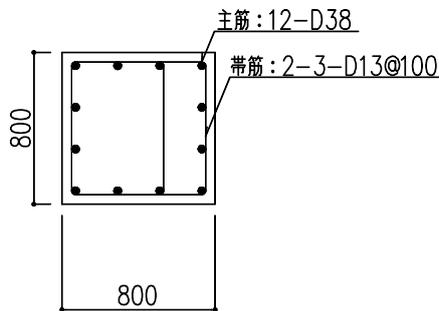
柱の配筋図 (地下2階, X4/YP 通り, 柱頭部) (単位:mm)
